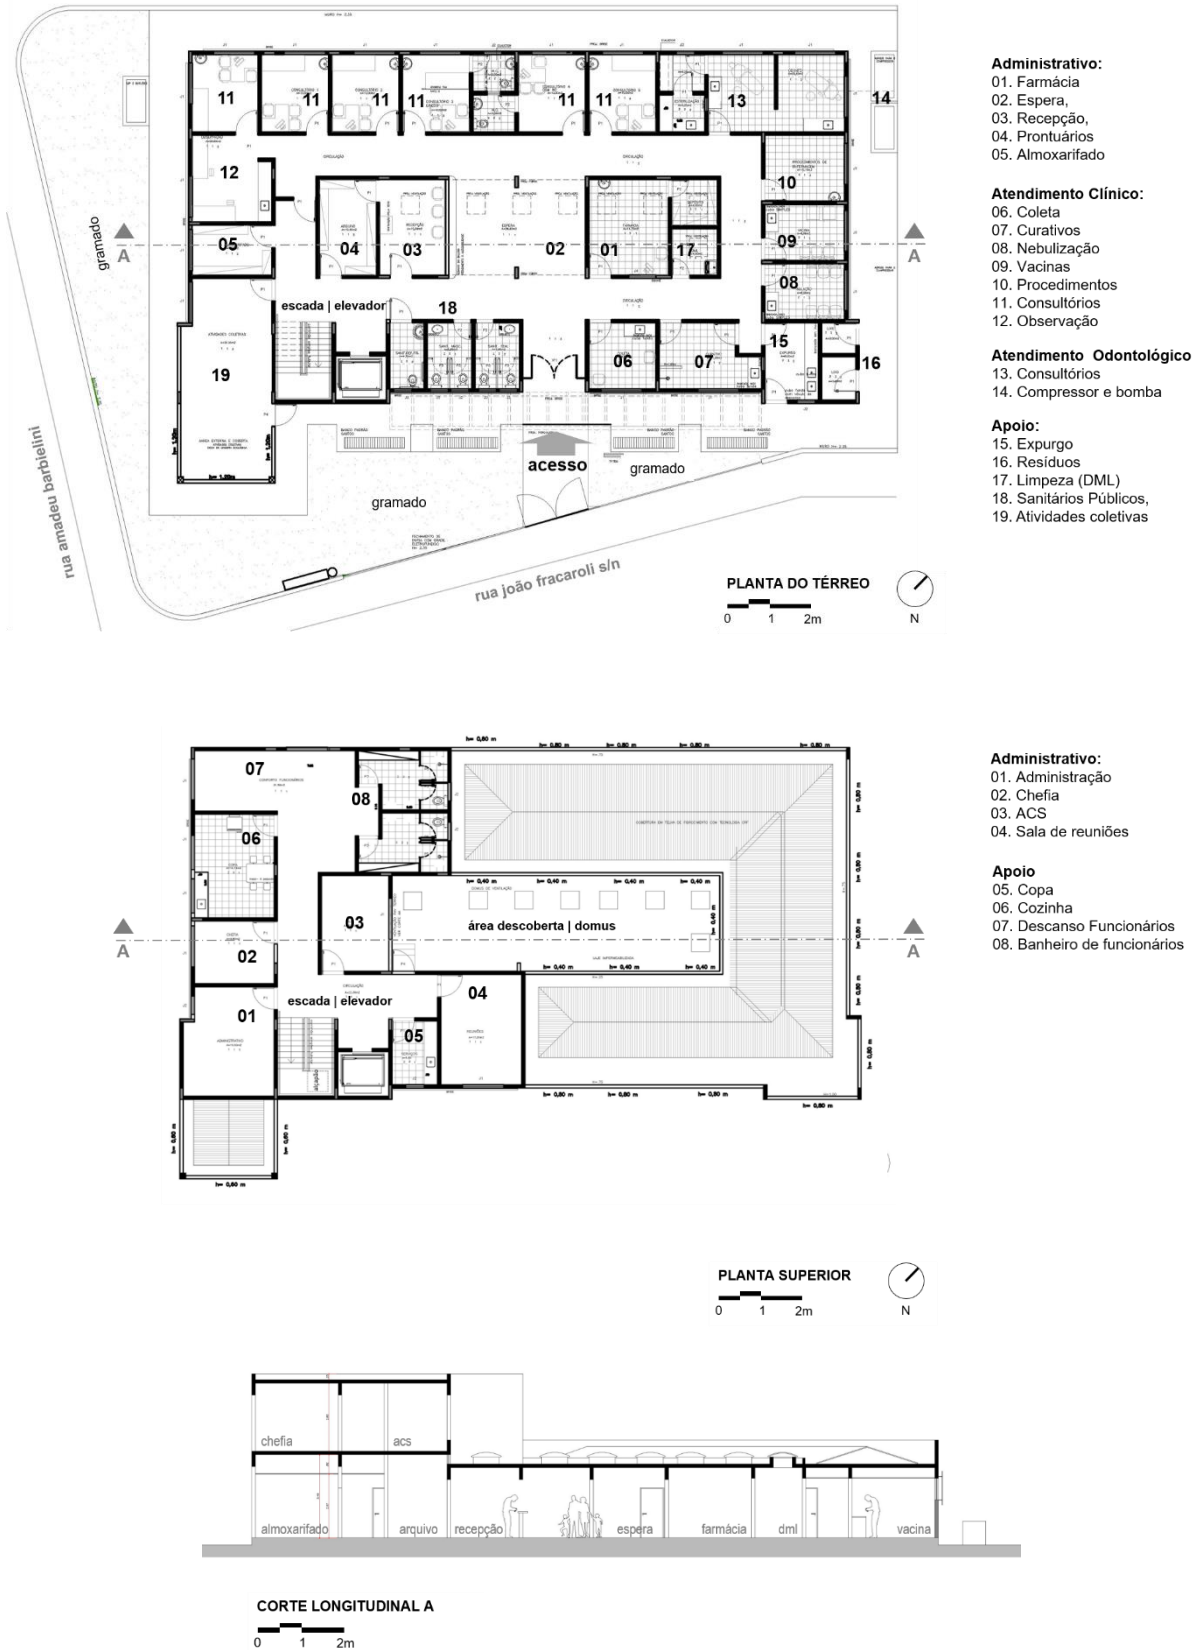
UBS Ponta da Praia. Planta arquitetônica e corte utilizado a para vistoria do local.
